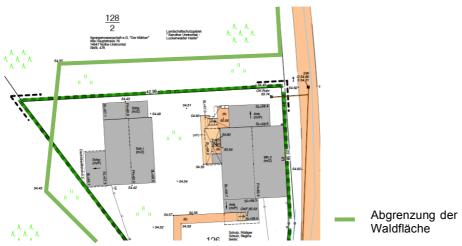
Abgrenzung der Waldflächen im Plangebiet
